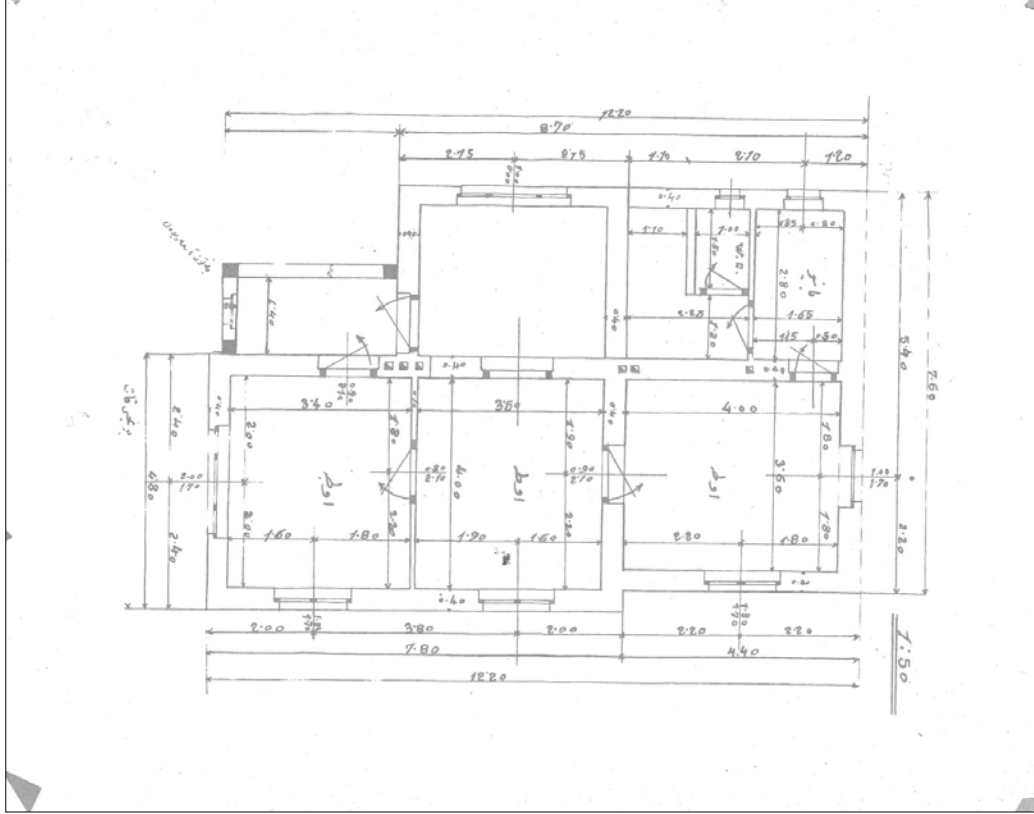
AEI Memurun ve Müstahdemin binası, plan, kesit ve görünüş çizimleri [296]
